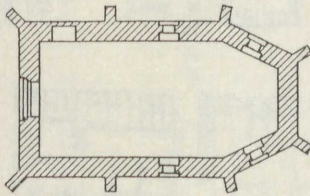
Bahn; St. Jürgen, Grundriss. 1 : 500.
